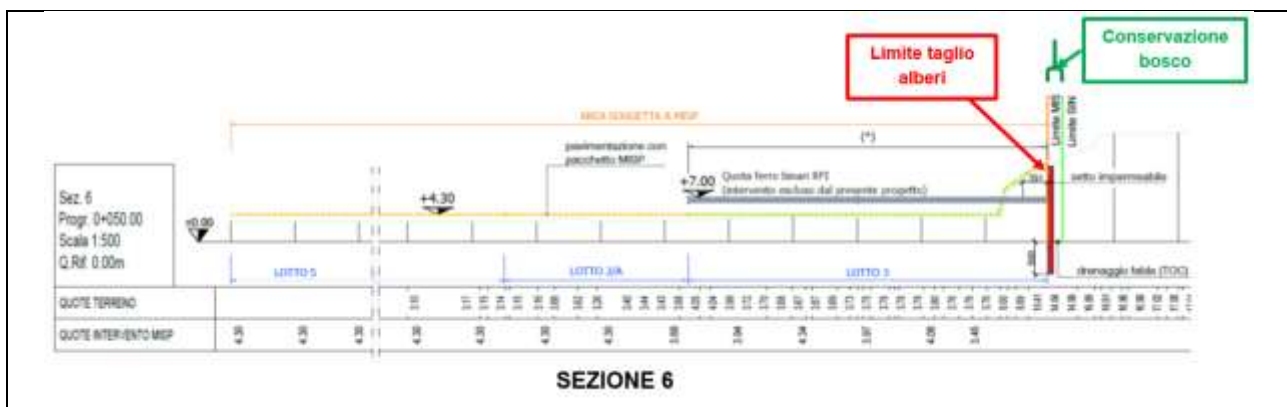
Sezioni di dettaglio con identificazione del setto impermeabile.
